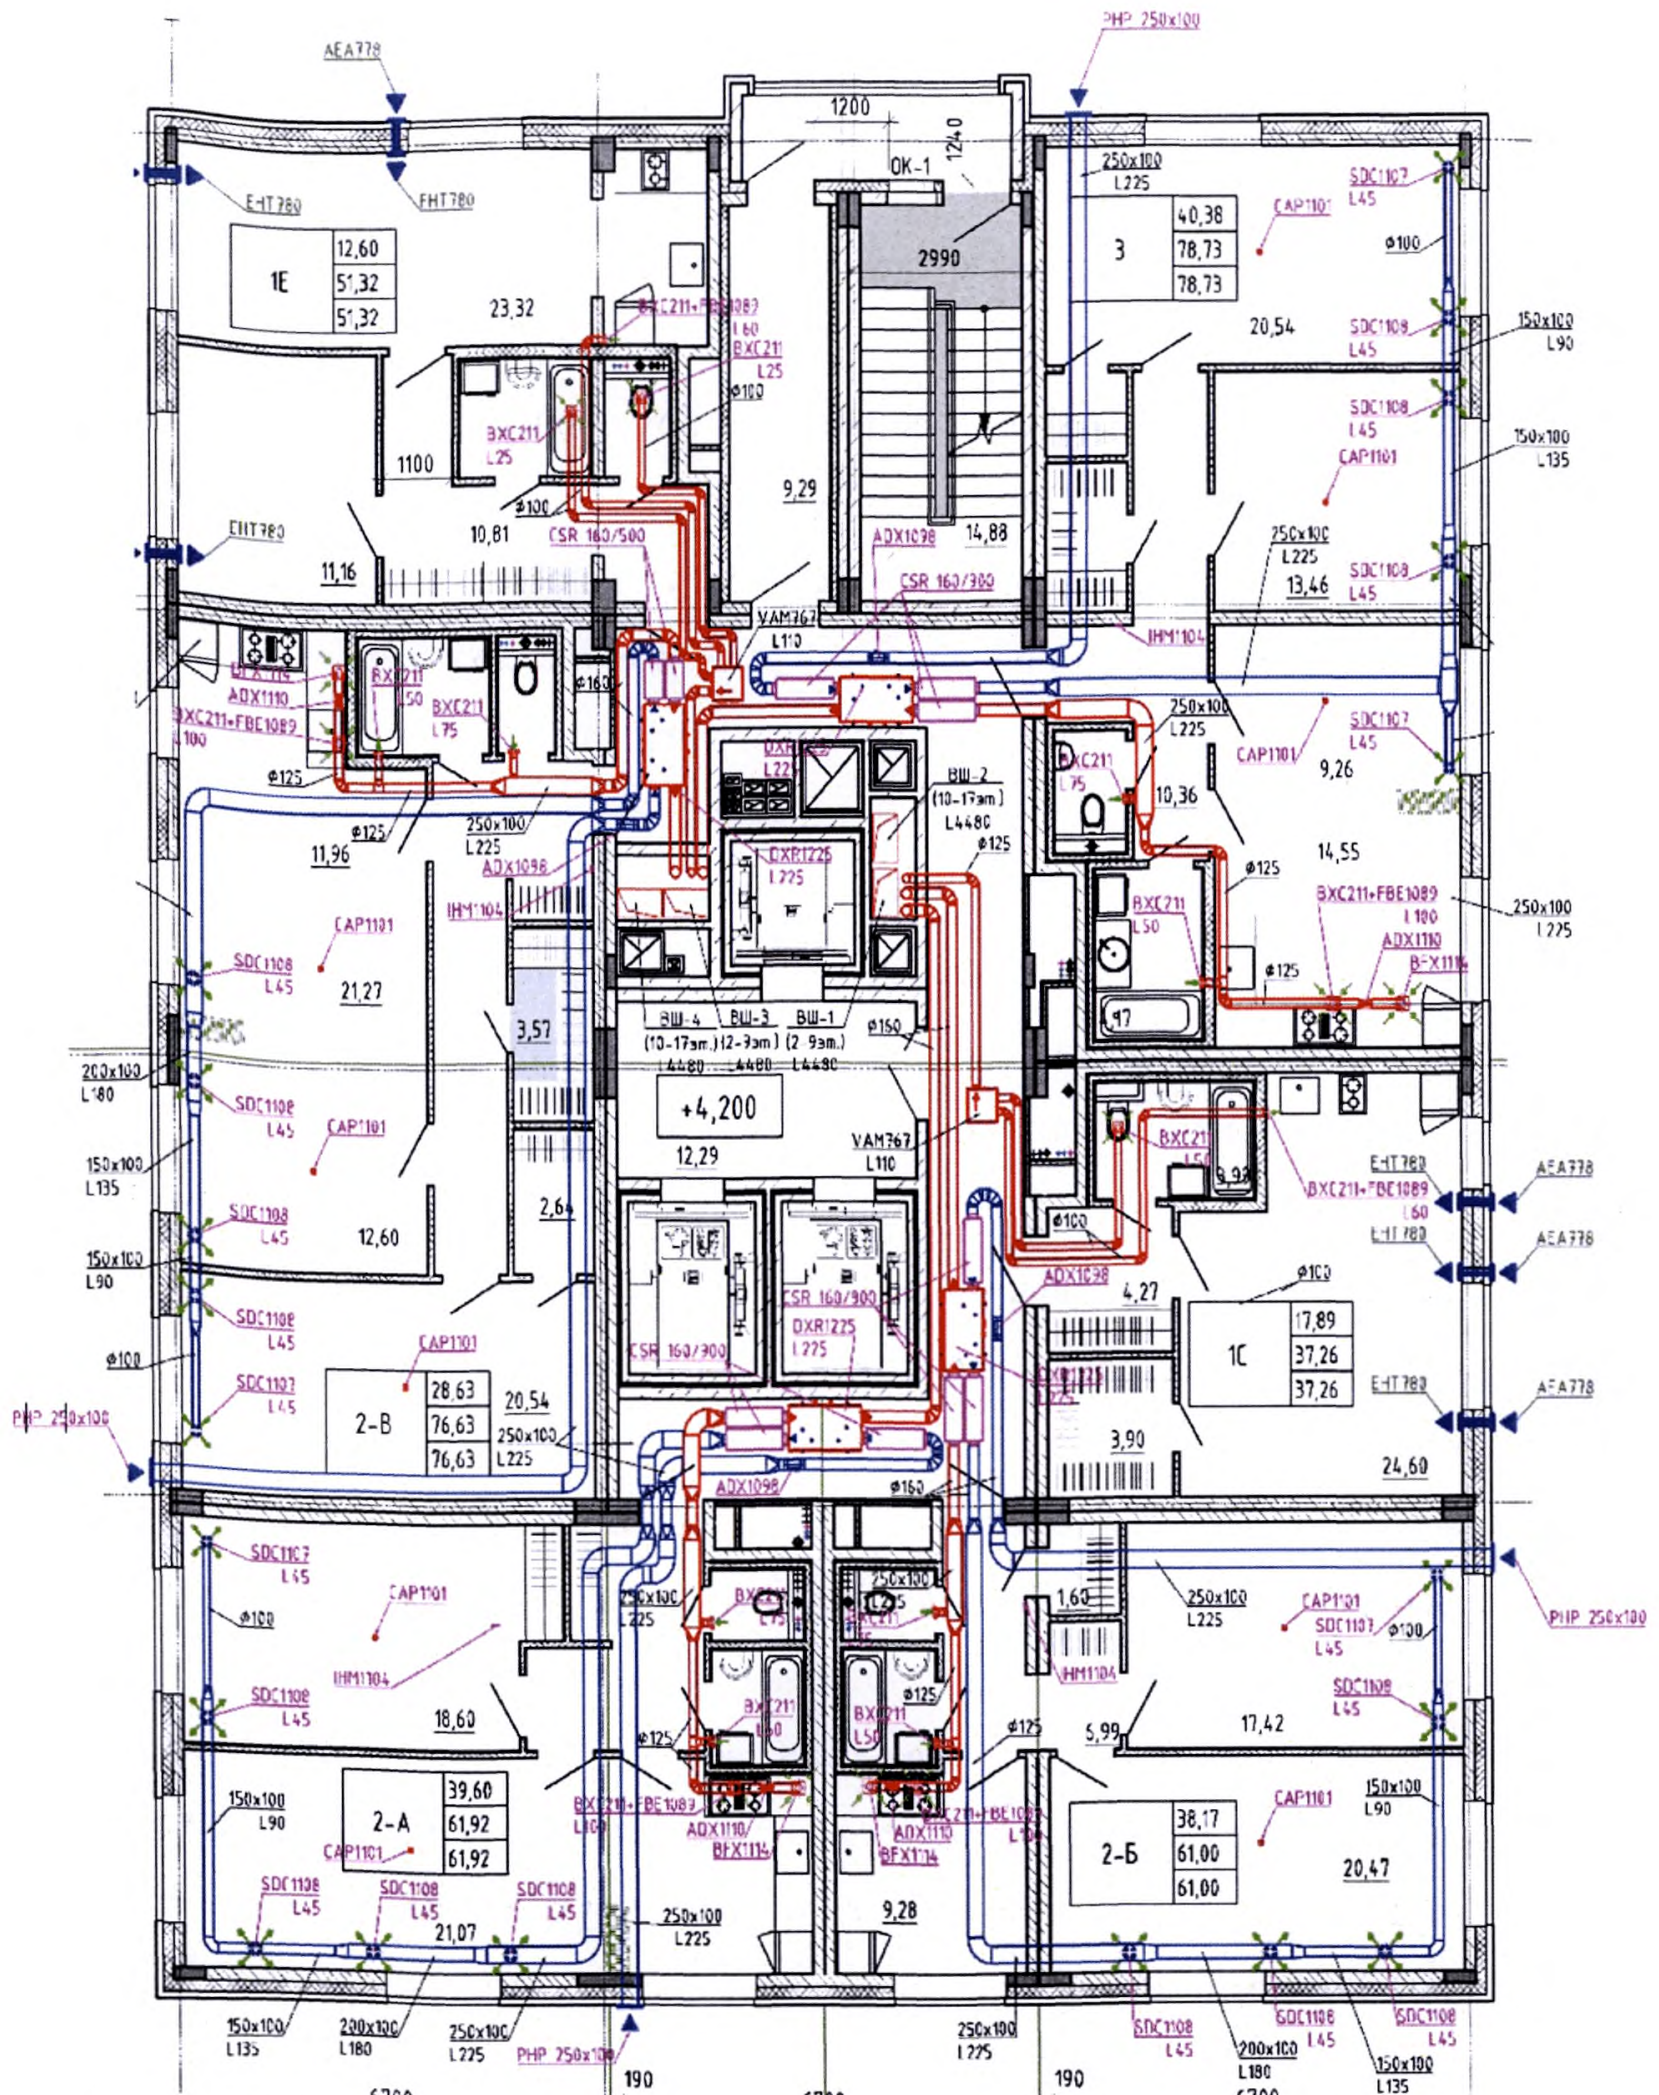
Схема рекуперации типового этажа на примере жилого здания
